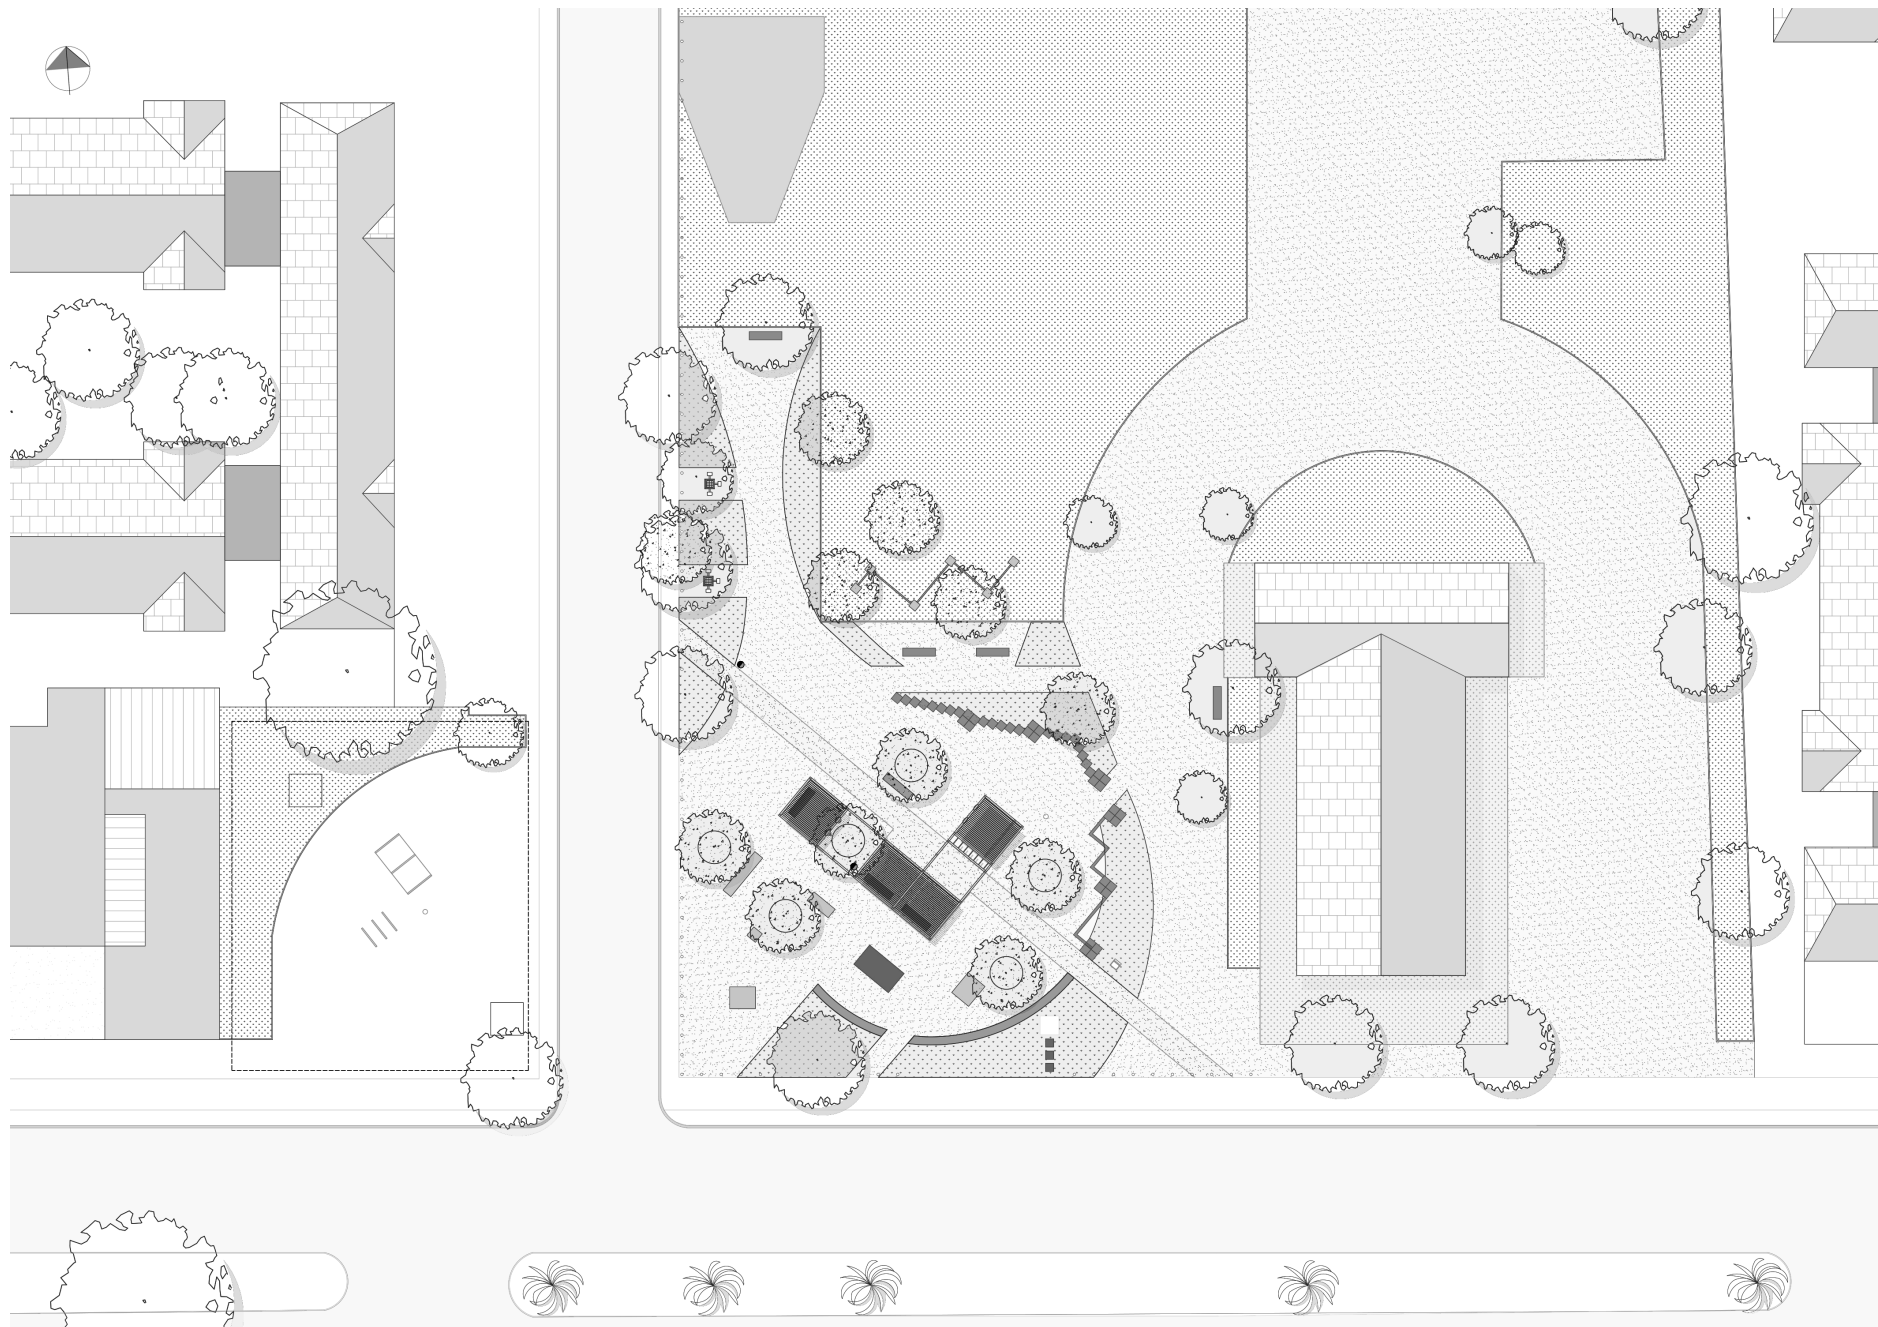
Planta proyecto de recuperación Plaza Tucapel Jiménez II. Fuente: Elaboración propia en base a planimetría de Kristine Lehmann Bazán, Arquitecta Proyectista en Fundación Mi Parque. 2019.
